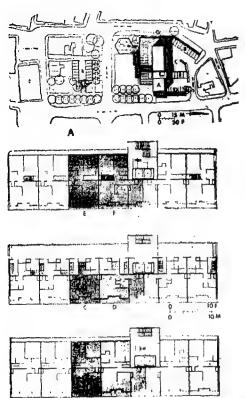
١٧ - ٦ : مسقط الدور الأرضى.
